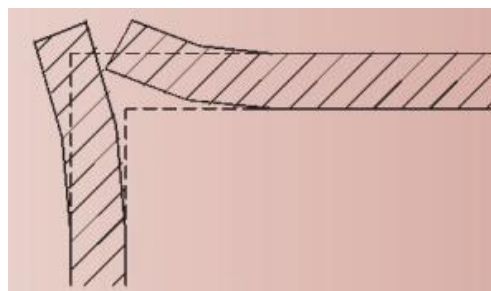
Deformação pela falta de junta de dilatação ou armadura
